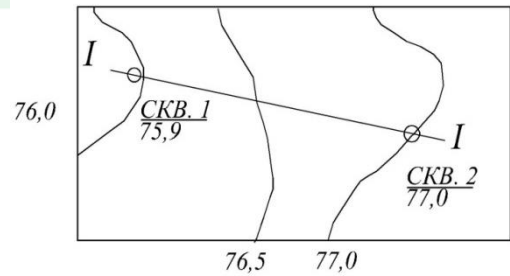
Схема расположения выработок грунта (план) на строительной площадке
